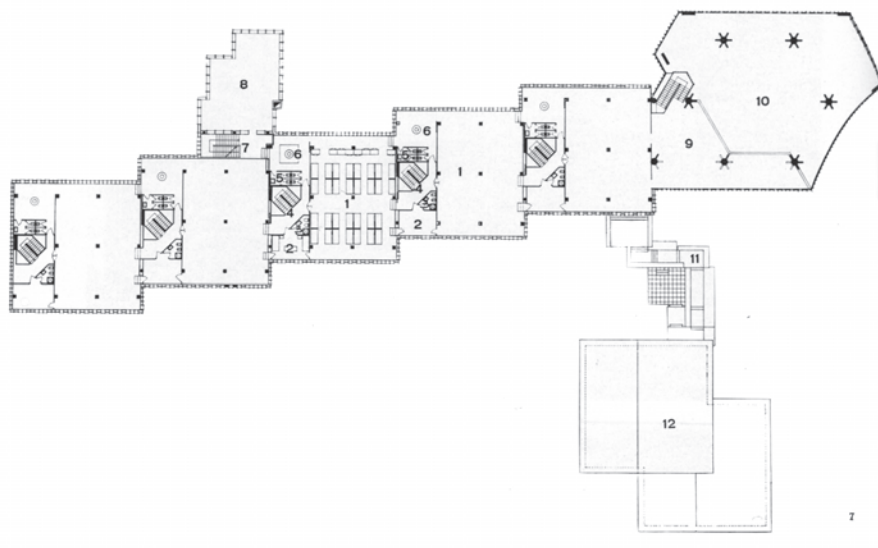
Olivetti-Ferienkolonie: Grundriss OG
